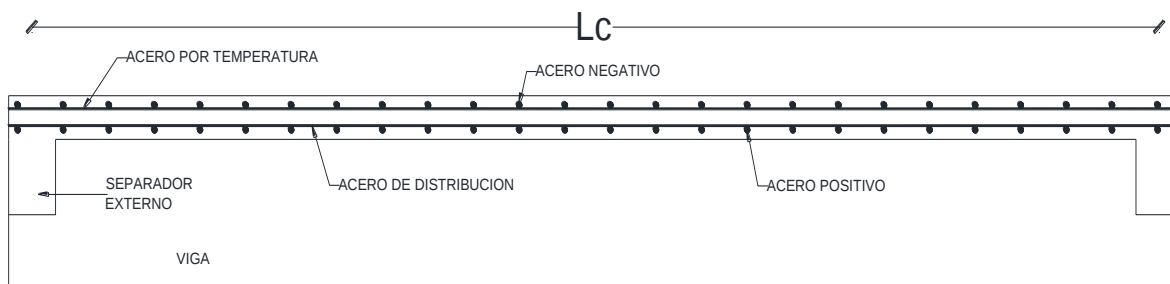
Aceros en la sección longitudinal de la losa.
